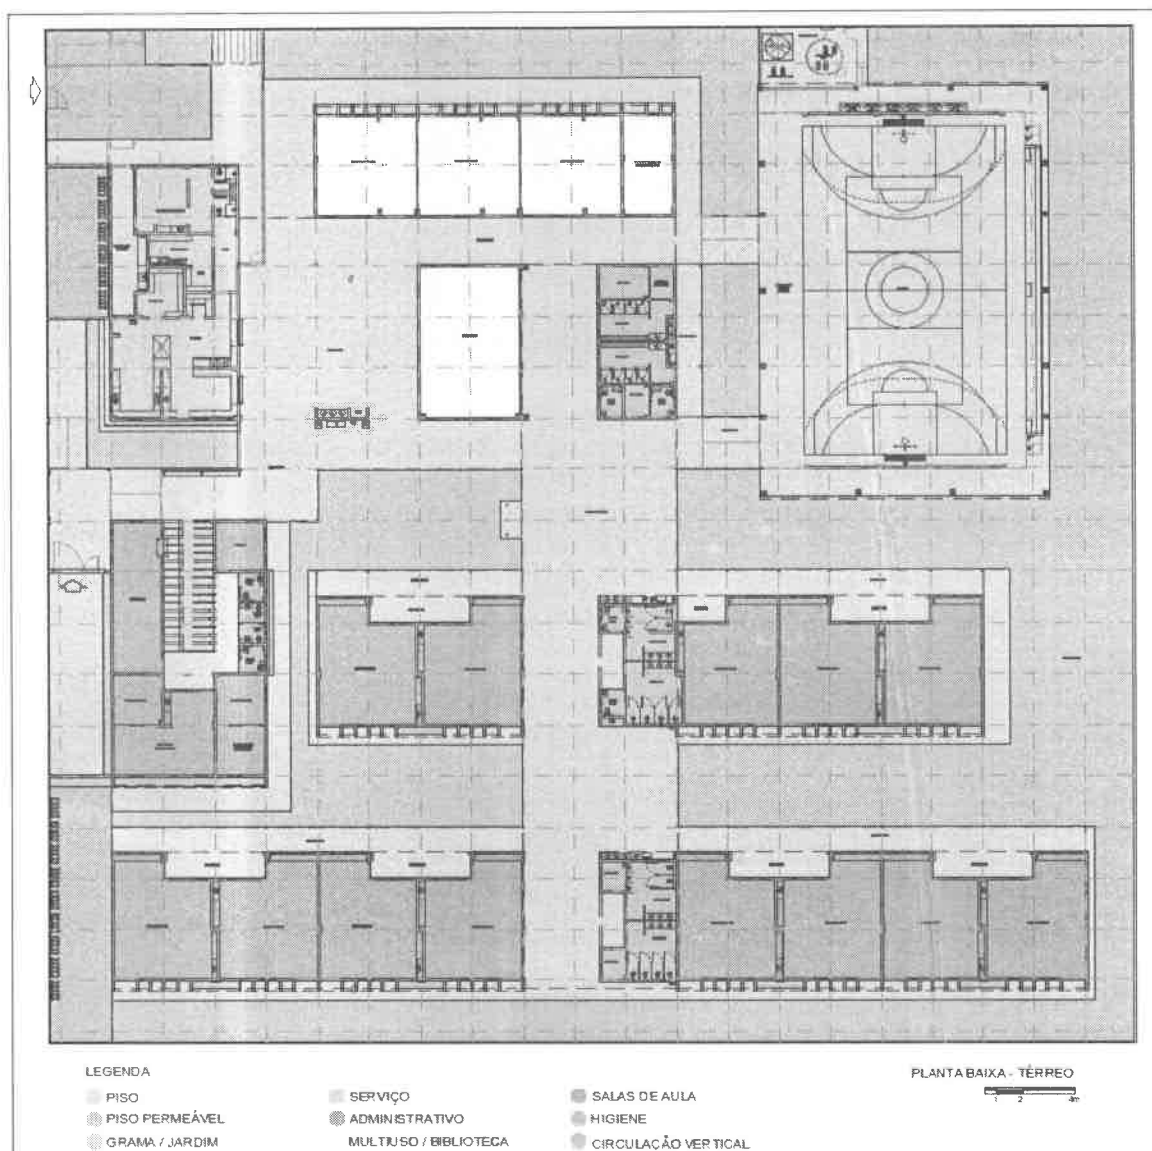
planta baixa de implantação dos blocos – Escola 13 Salas - Térreo
